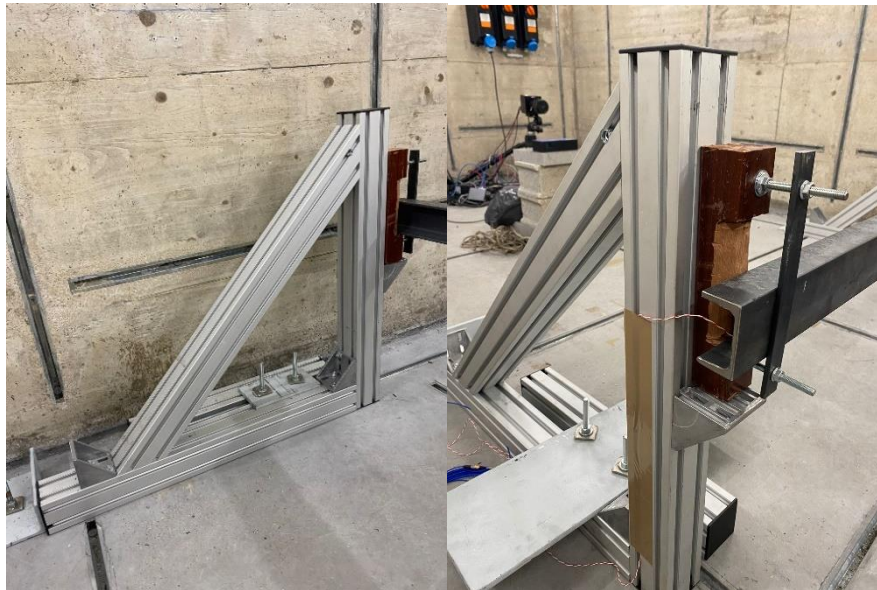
Perfil triangular de suporte da viga e apoio simples da viga.
